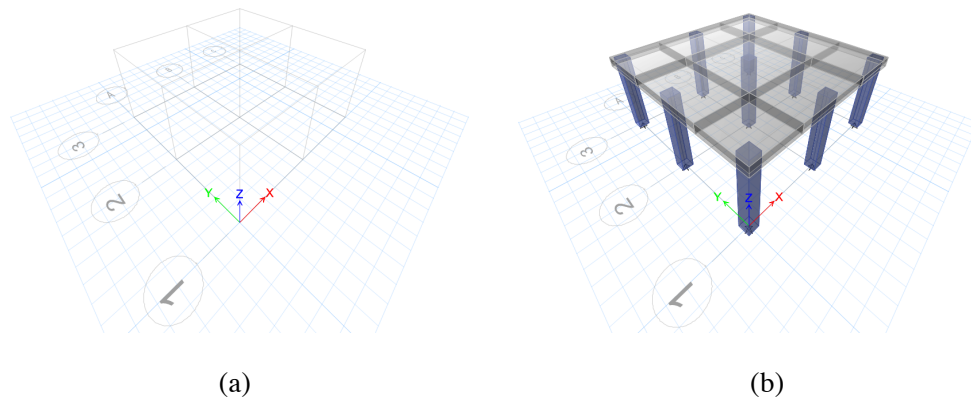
Modelo de edificio en ETABS (a) Malla rectangular utilizada. (b) Vista 3D de vigas, columna y losas
